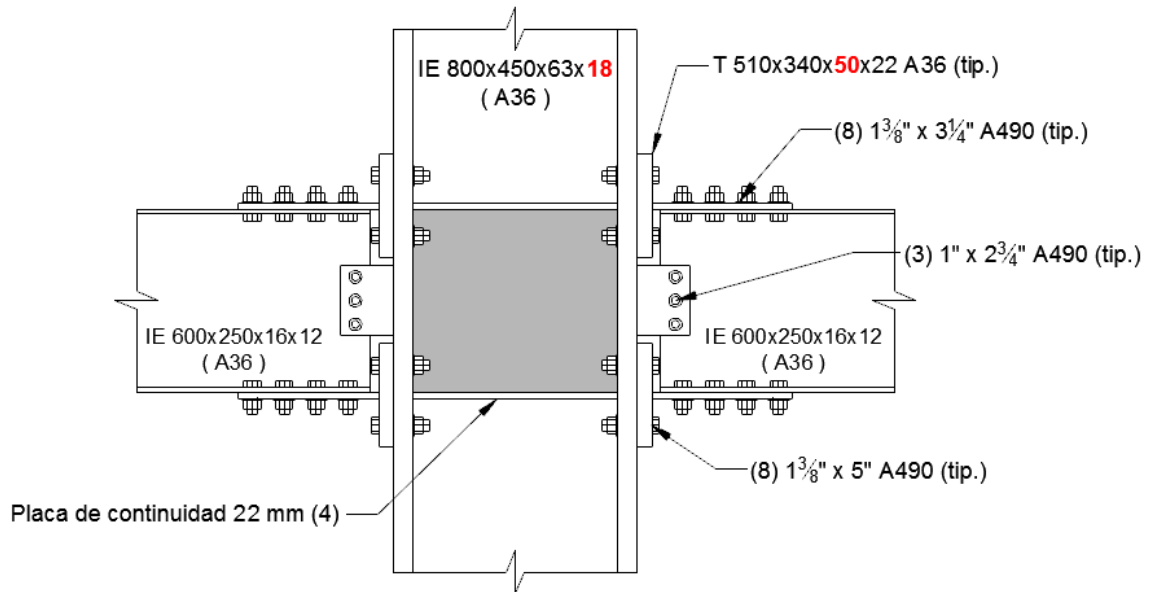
Detalle de conexión SE-03 (DBT1). Fuente: Salas (2016)
